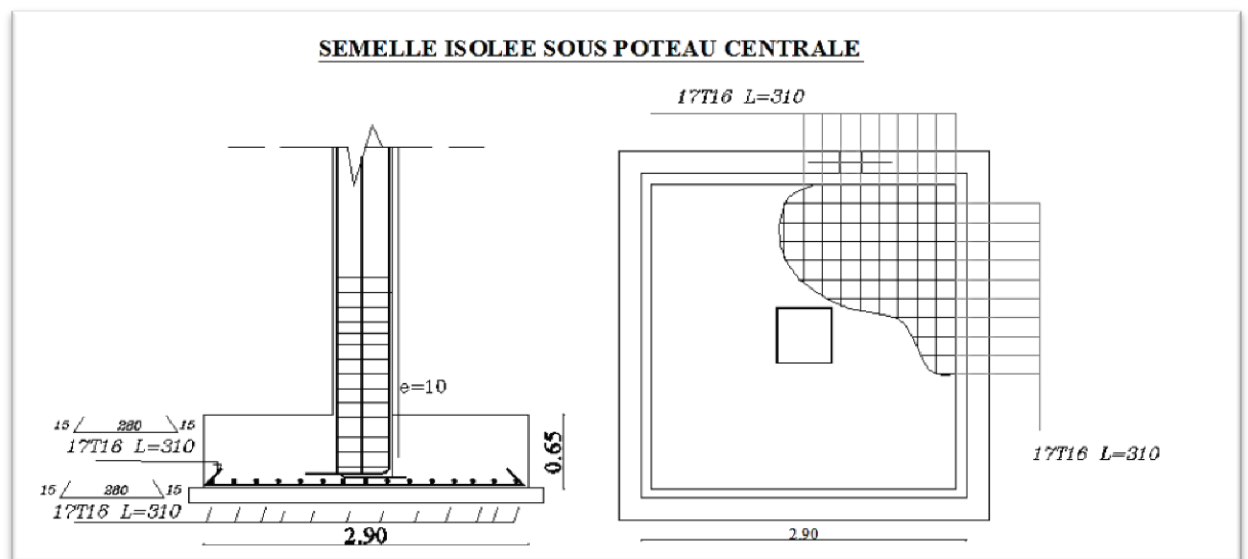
Schéma de ferrailage de semelle isolée intermédiaire (x-x).
